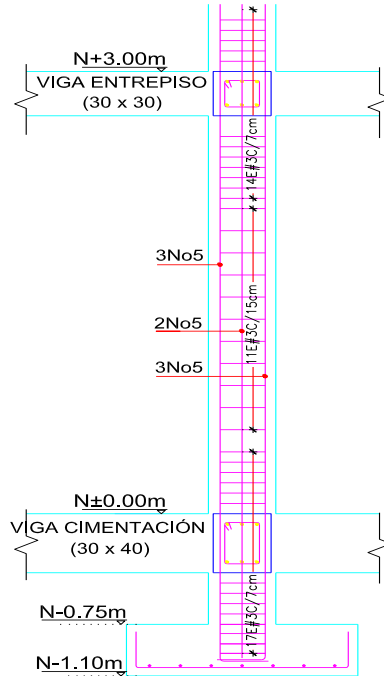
DESPIECE COLUMNA C3 EN EL NIVEL 1 DEL BLOQUE 2.
